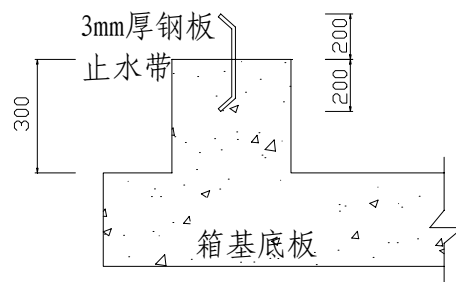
地下室外墙与基础底板浇筑施工缝留置位置示意图
